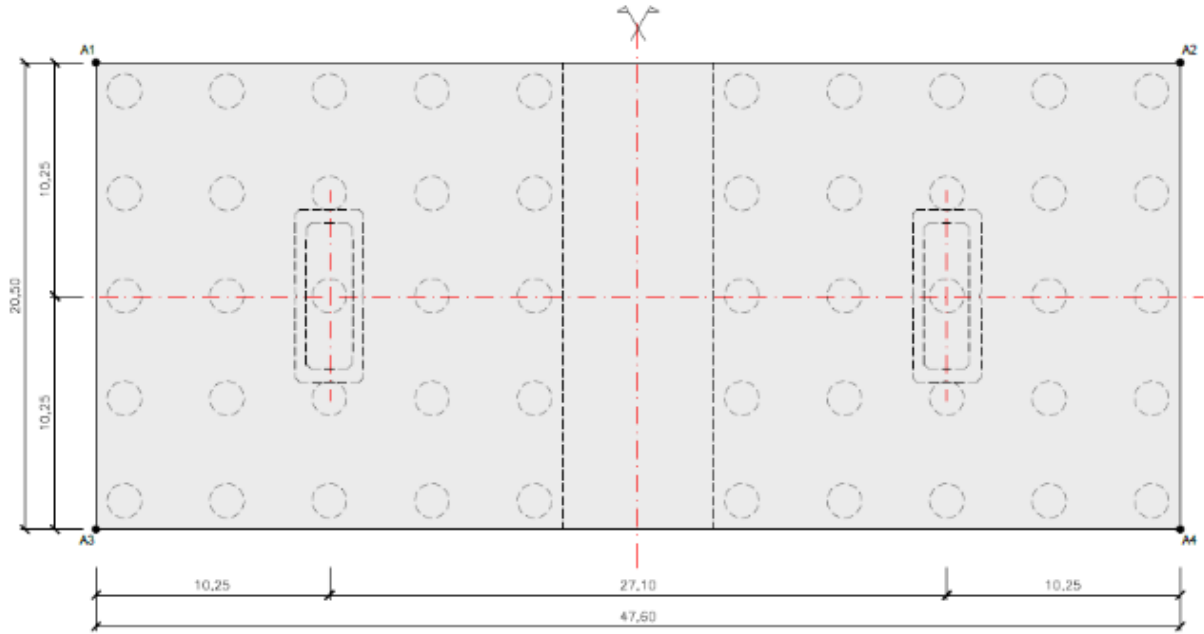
Planta de encepado de columna tipo DELTA, P-33. (IDEAM, 2016)
